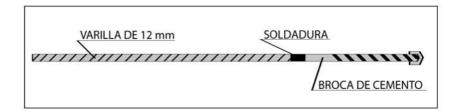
Esquema de la broca soldada a la varilla corrugada, para perforar la pared de adobe. Modificado de: P. Bonilla, "Manual técnico para el reforzamiento sísmico de edificaciones de mampostería no confinada y no armada, de ladrillo o adobe", tesis de grado, 2002, EPN, Quito. Director P. Placencia.
